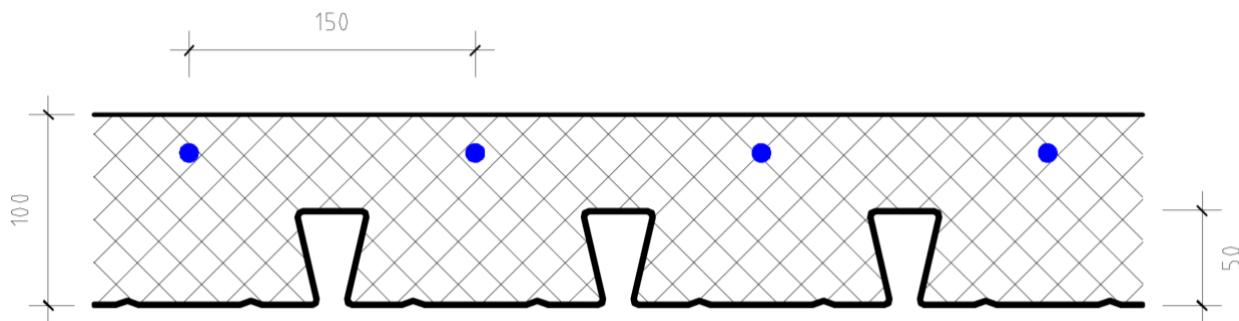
Querschnitt Blechverbunddecke mit Längsbewehrung
